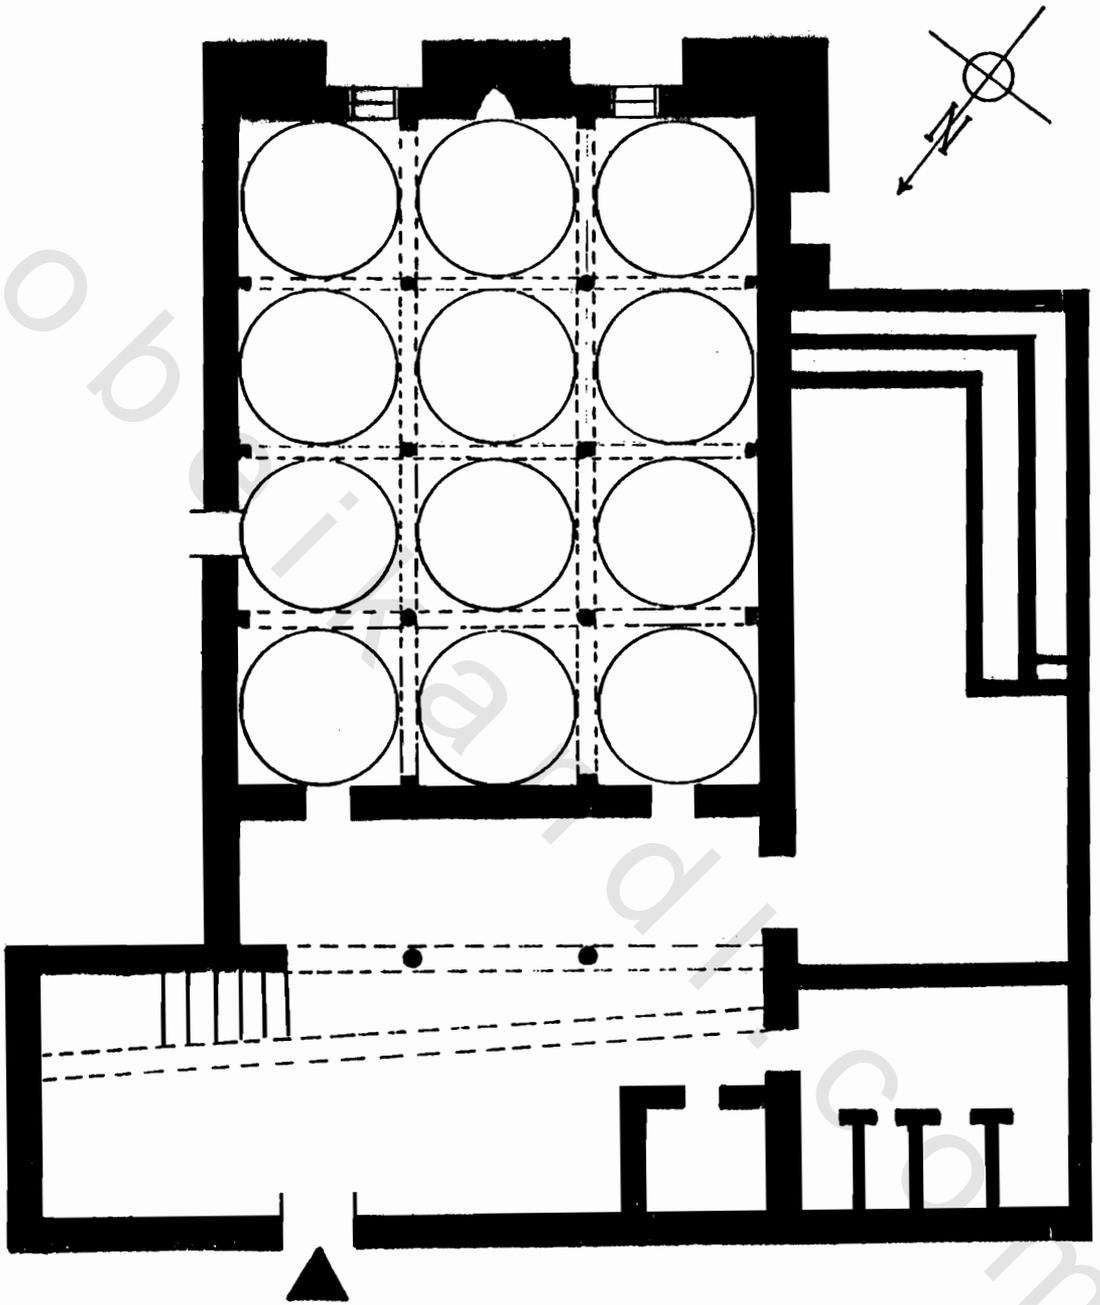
مسقط أفقي لجامع الناقة . (عمل للباحث)
